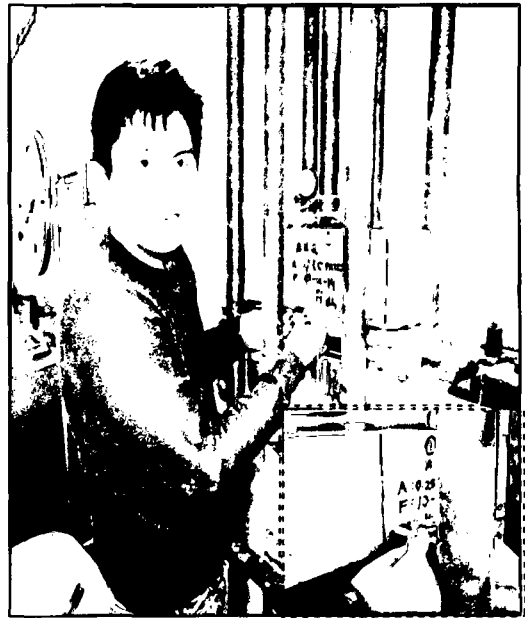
Medida de ancho y largo de fisura de los especímenes ensayados a flexión.
